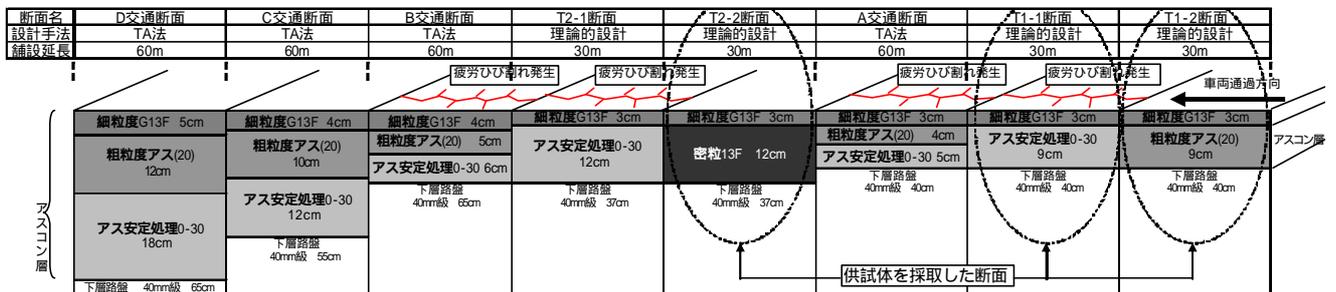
美々試験道路の舗装断面と供試体採取位置の概要
